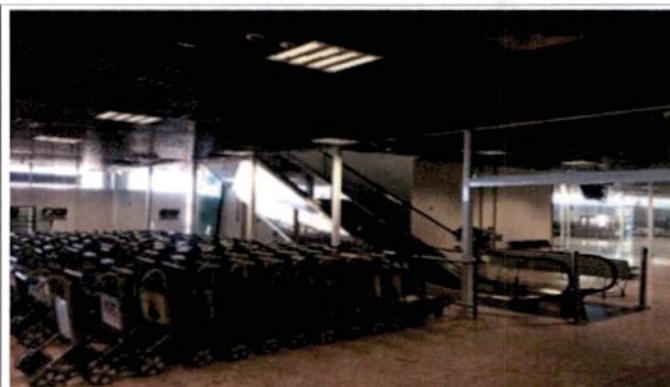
Instalação da estrutura metálica e divisórias em vidro
